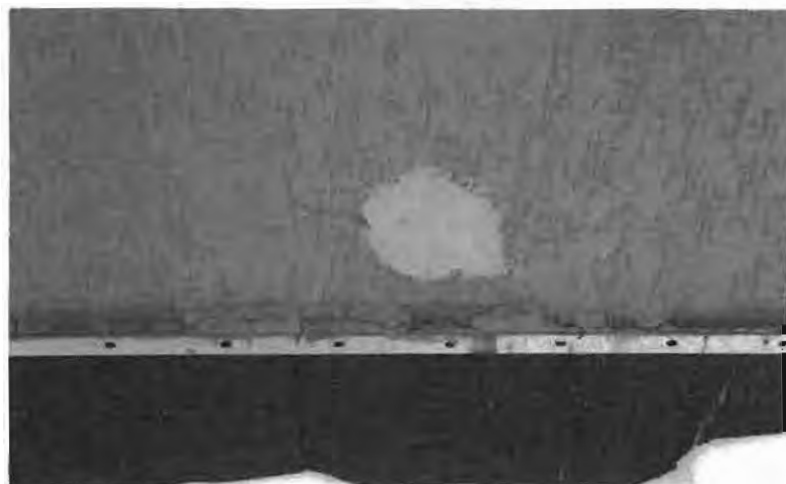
Фрагмент примыкания гидроизоляционного ковра к стенке в осях Гс-Жс/Зс (по проекту шифр 07.001.74/14-04Б-АР3, 3 секция, лист 5). Разрушение герметика. Локальный скол по краске в отделке фасадов. Следы грязи и пыли на герметике и на прижимной металлической планкой. Трещины по поверхности герметика.
